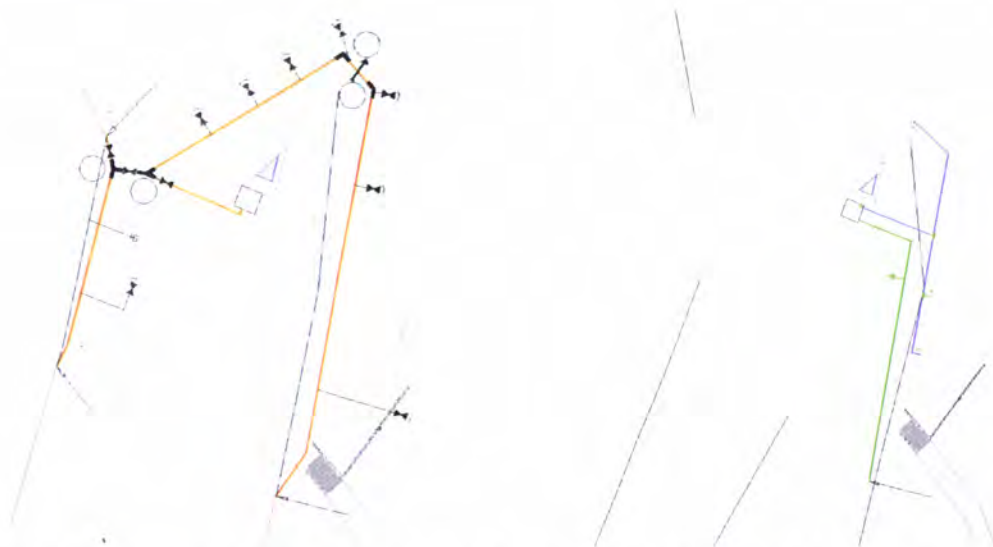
Rede de Saneamento Planta de projecto (Fonte C.M. Alandroal)
